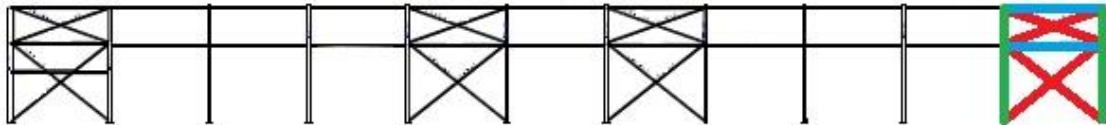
Fachada lateral con arriostramiento lateral resaltado
